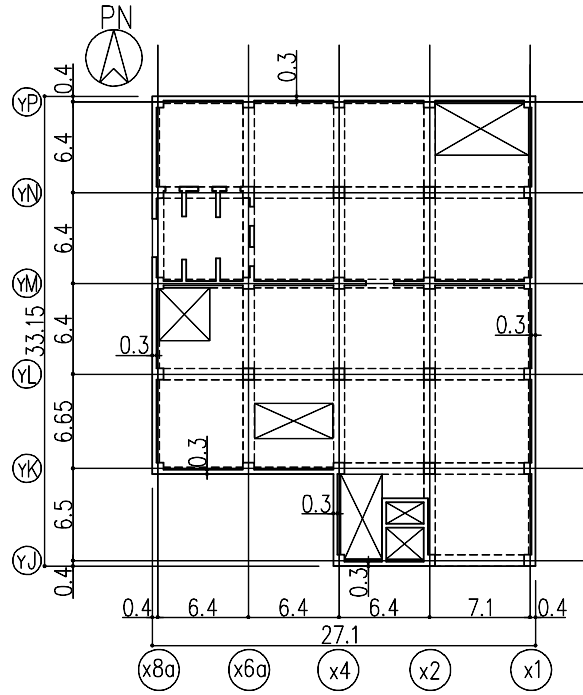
地上2階平面図 (G.L.+4.7) (单位:m)
